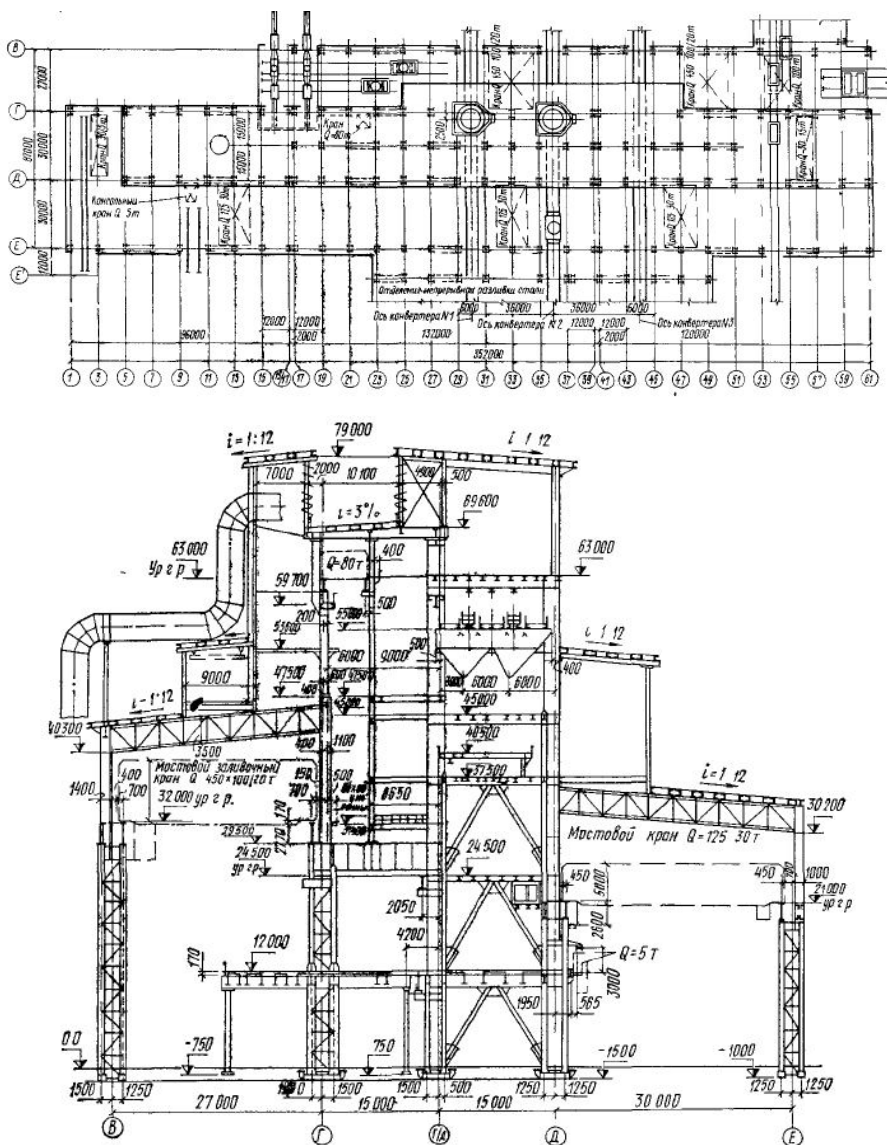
План и поперечный разрез здания кислородно-конверторного цеха ОАО «ММК»
